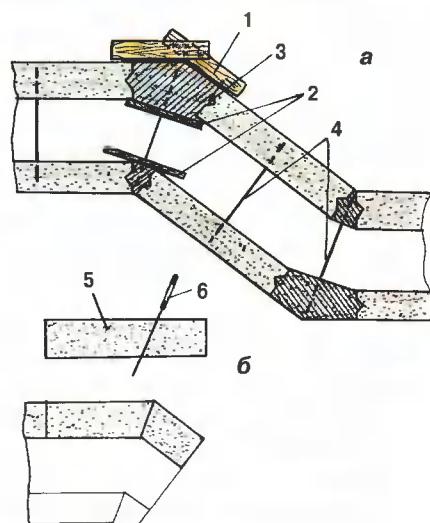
Варианты выполнения перевязки трёхслойных стен по непрямому углу:
